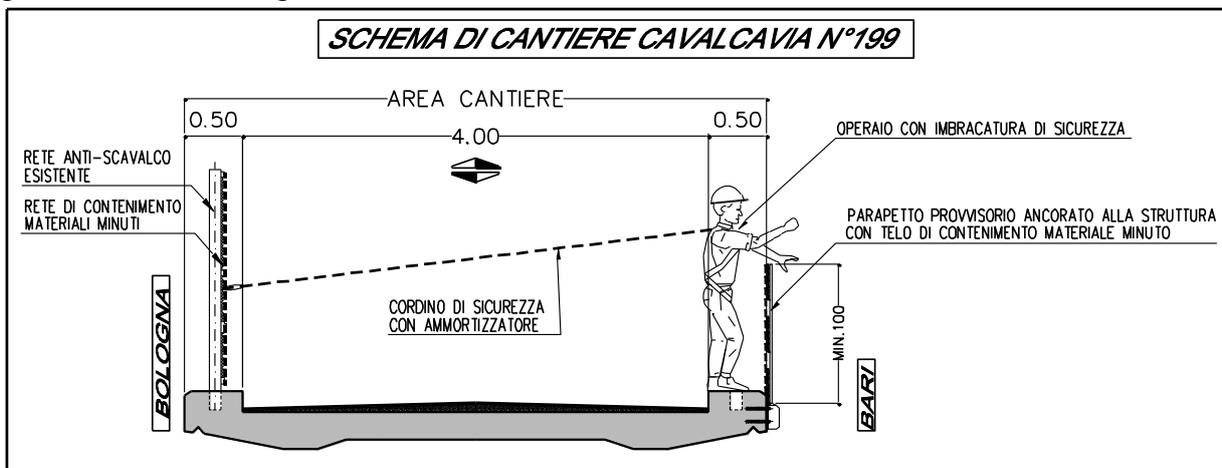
C – Schema Organizzazione del cantiere cavalcavia n. 199.
